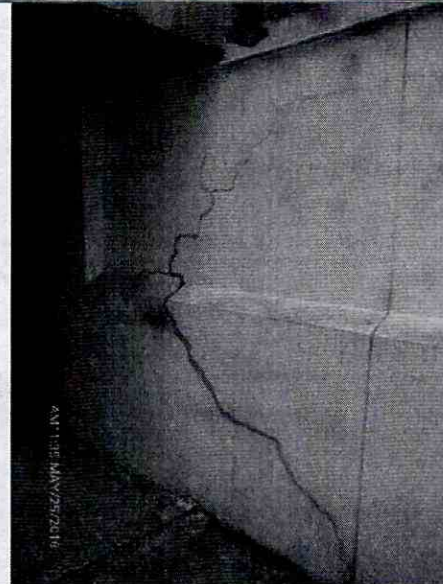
Presencia de grietas y hundimientos en losas de piso de la zona de estacionamiento del Conjunto Residencial La Esperanza I y II P.H. de la Calle 163B No. 45 - 32, en el Sector Catastral Britalia de la Localidad Suba.
